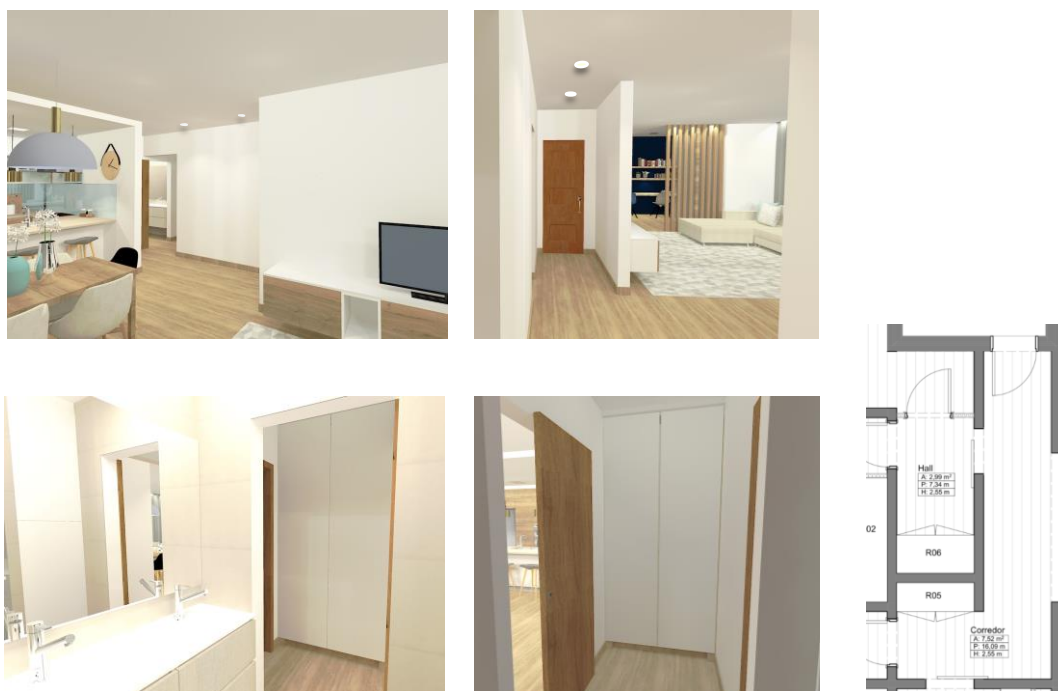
Corredor, opção B. Imagem 3D e planta.
